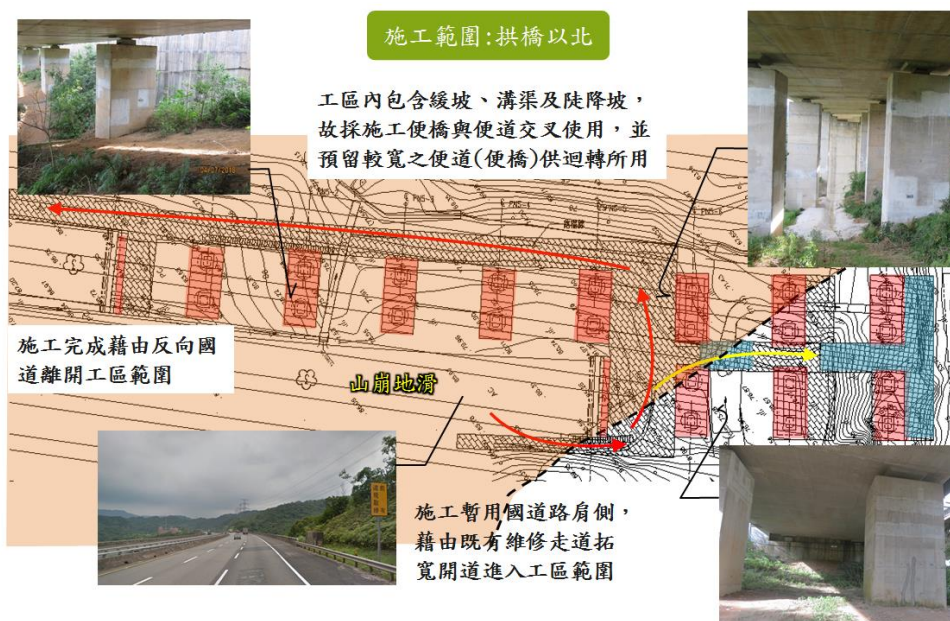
支承補強施工便道、便橋配置示意圖(拱橋以北)
